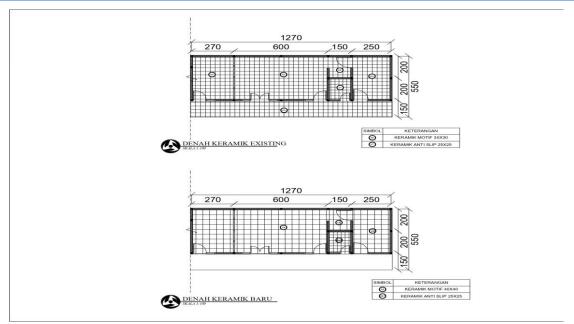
Denah Existing Zona 2 dan Denah Rencana Existing Zona 2
